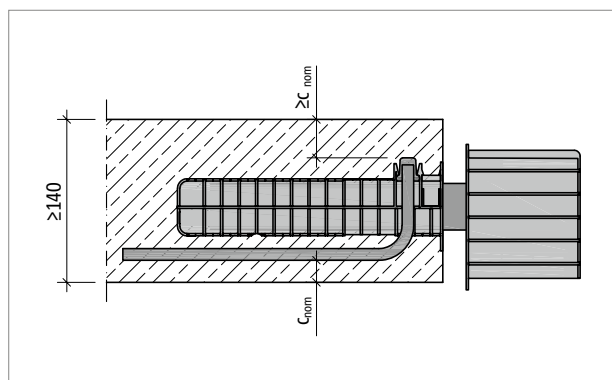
Tronsole® Q: Einbau bei Plattendicke $h \geq 140$ mm unter Beachtung der Betondeckung c_{nom}
